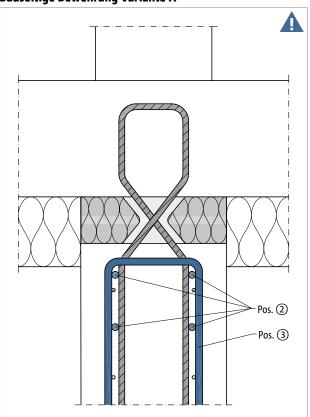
Schöck Sconnex® Typ W-N-VH: Bauseitige Bewehrung Variante A; der außenliegende Stabstahl Pos. 2 stützt die Querkraftstäbe des Schöck Sconnex® gegen die Bauteiloberfläche ab
